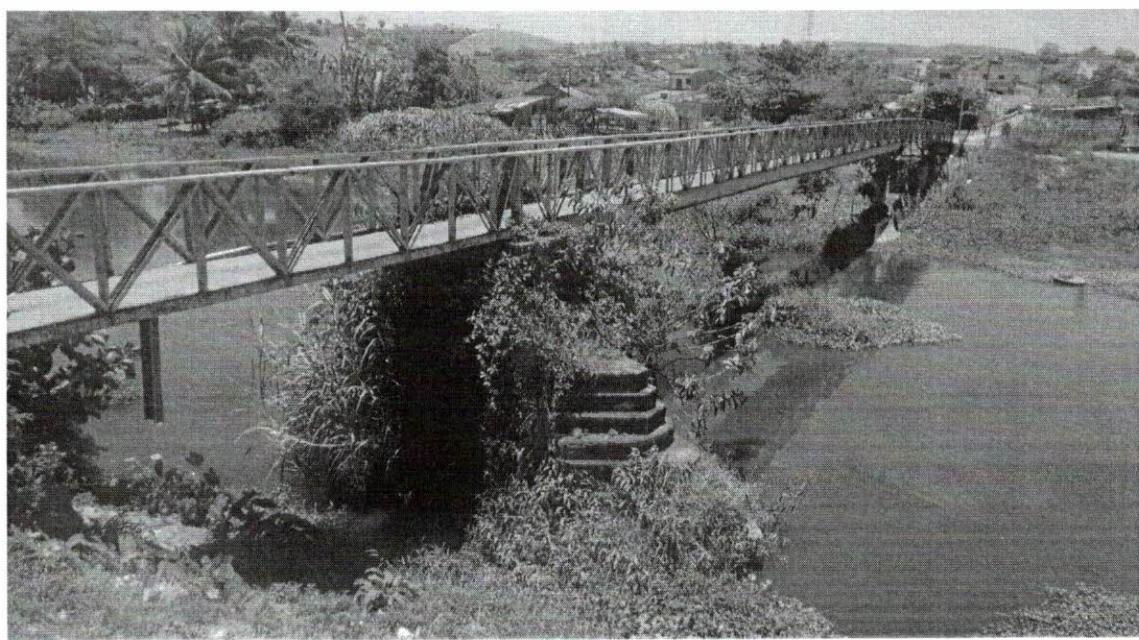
Vista Lateral do local onde será implantado a pante sobre o rio Canhoto
